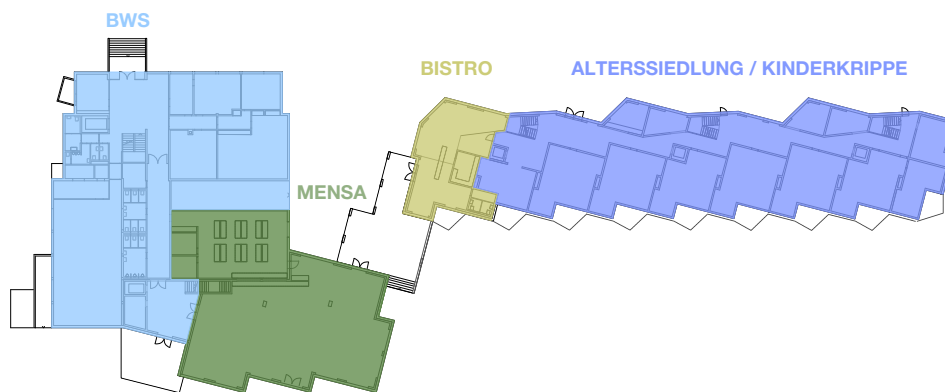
Grundriss Eingangsgeschoss - Stand Wettbewerb November 2014
